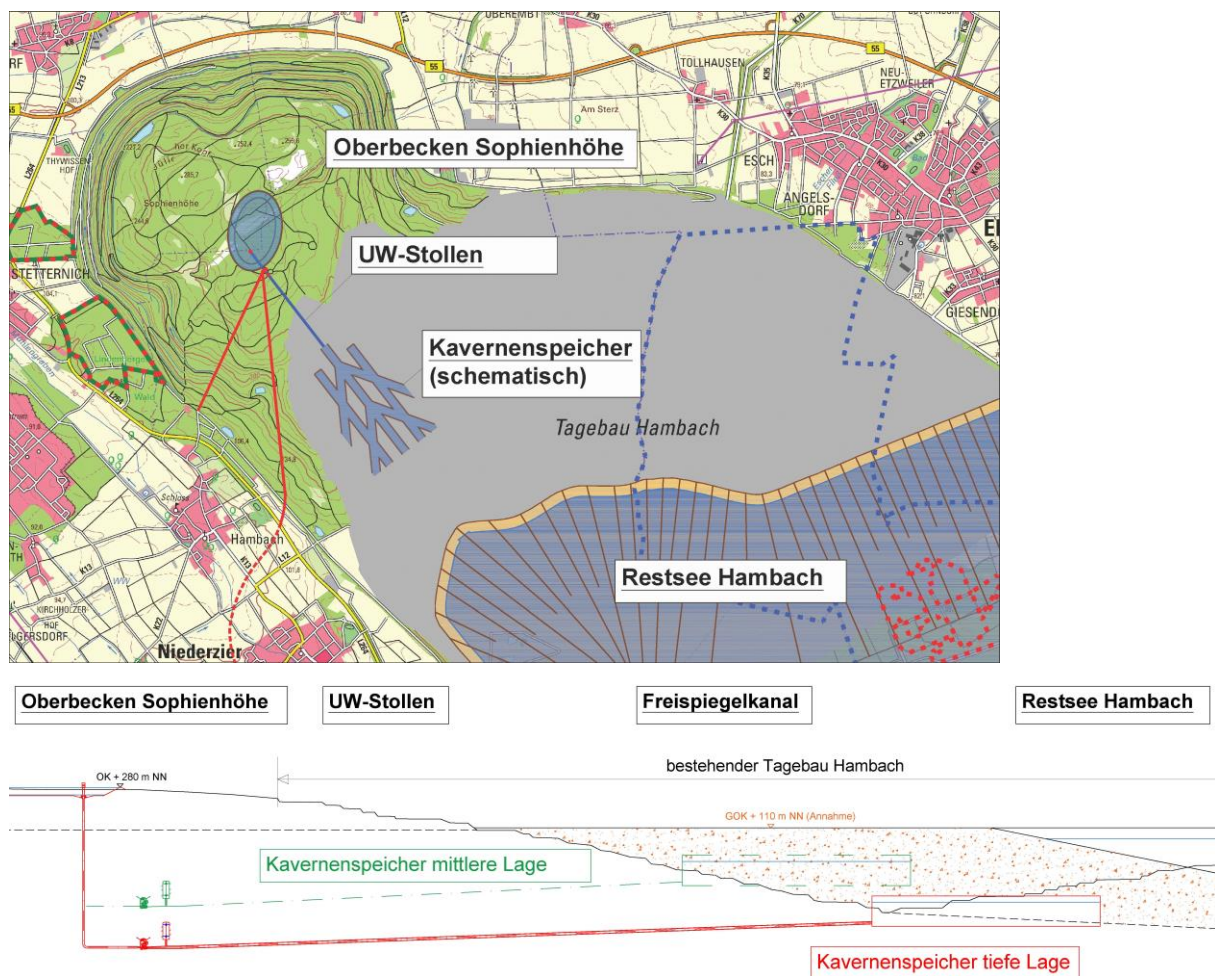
Lageplan und Längsschnitt für Alternative „Kavernenspeicher“ in PSW-Variante 2.4
